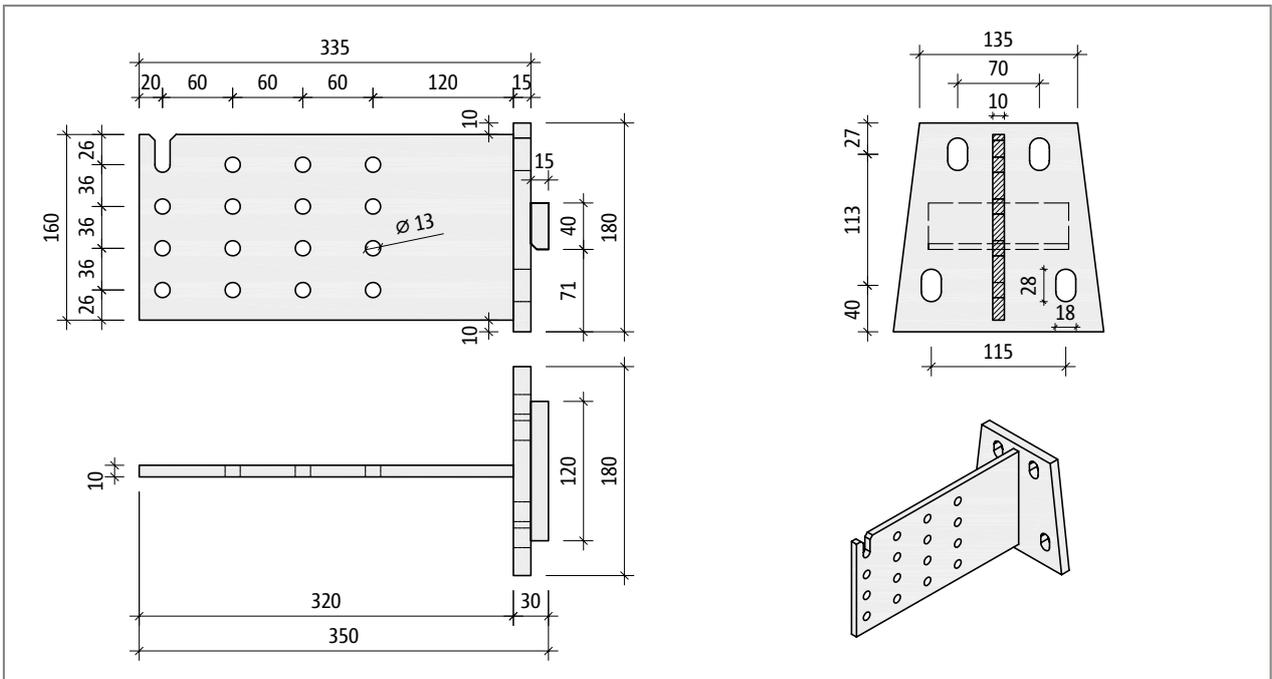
Schöck Isokorb® T Typ SK mit Stahlschwert: Stahlschwert mit Stirnplatte und Knagge
